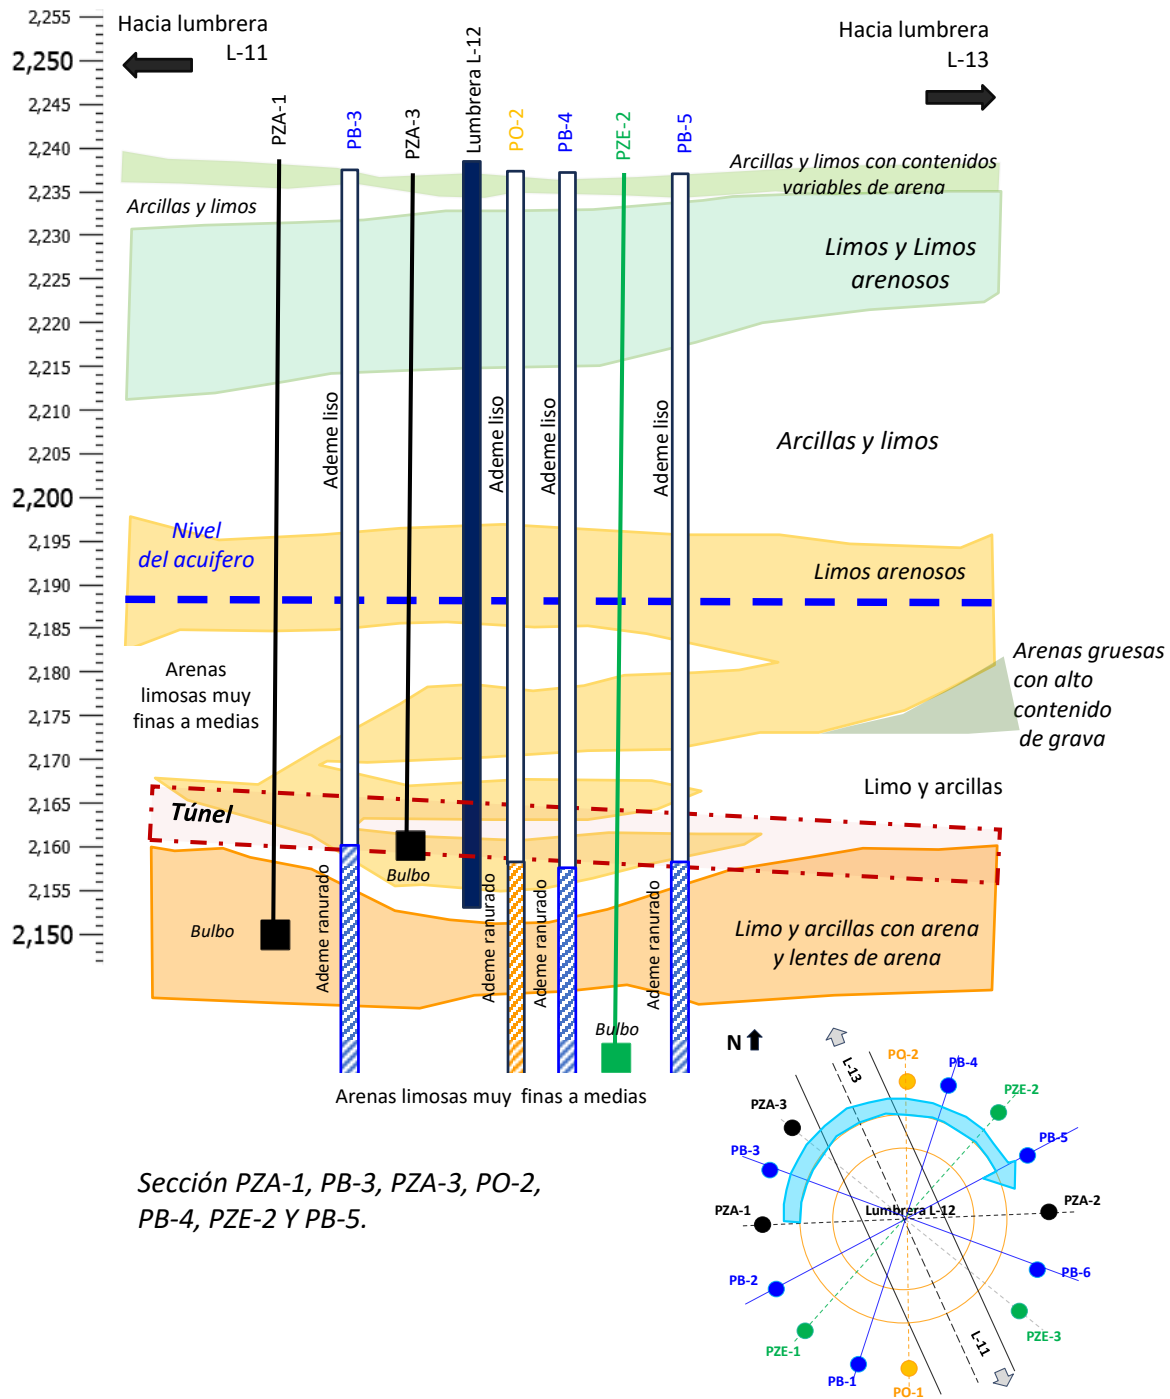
Proyección en perfil de pozos de abatimiento e instrumentos para proyecto piloto de abatimiento(complemento).
